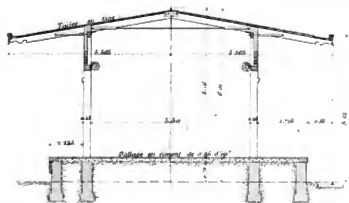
Ecl. 1/20 Type N°2 Rlevation
